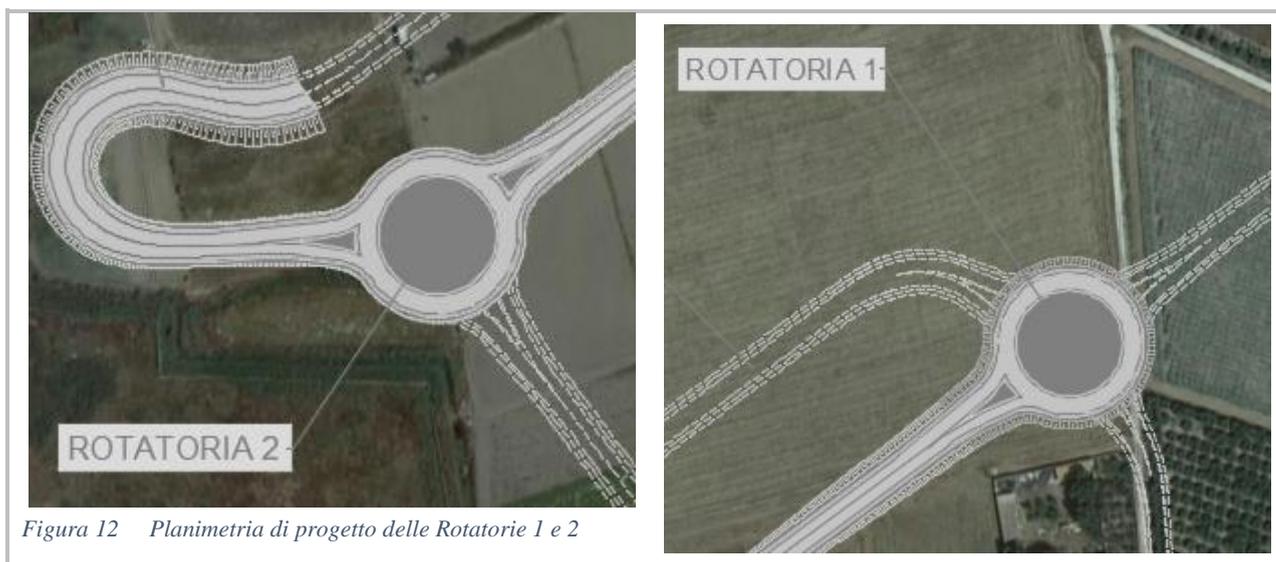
Planimetria di progetto delle Rotatorie 1 e 2
